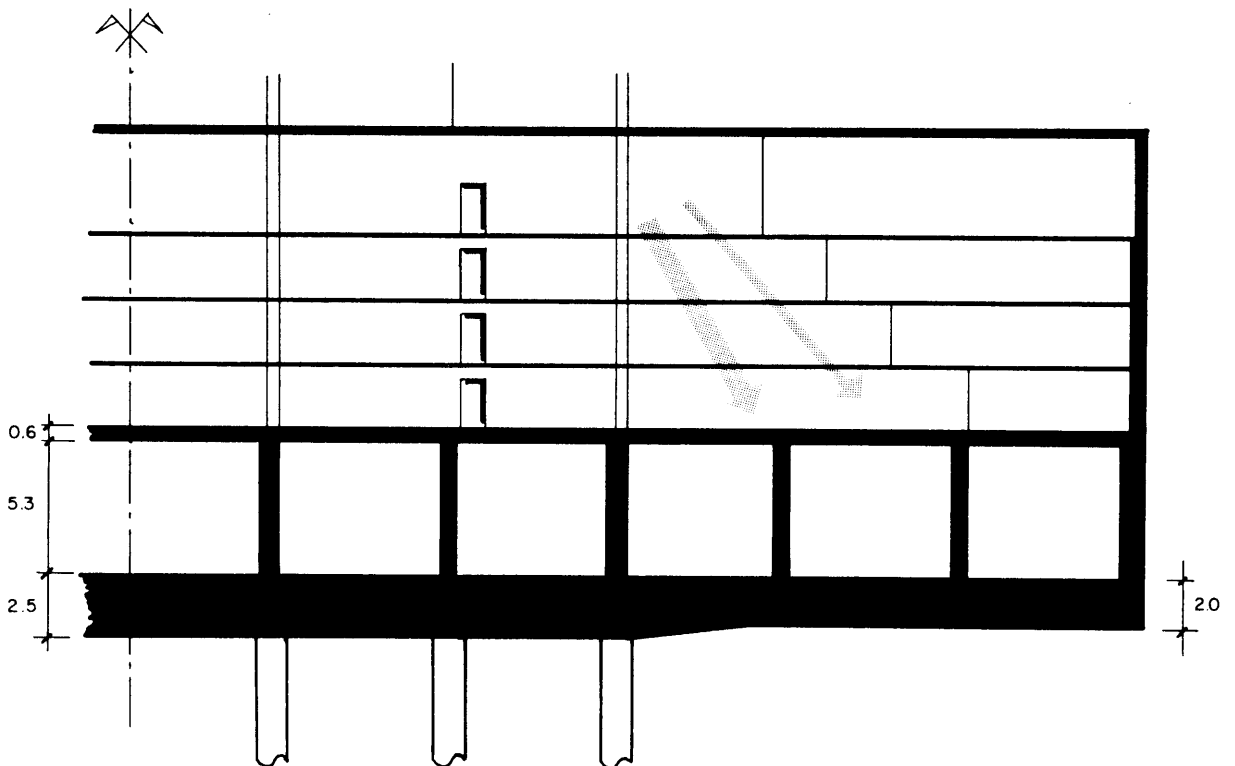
Längsschnitt durch Bodenplatte und Fundationskasten
